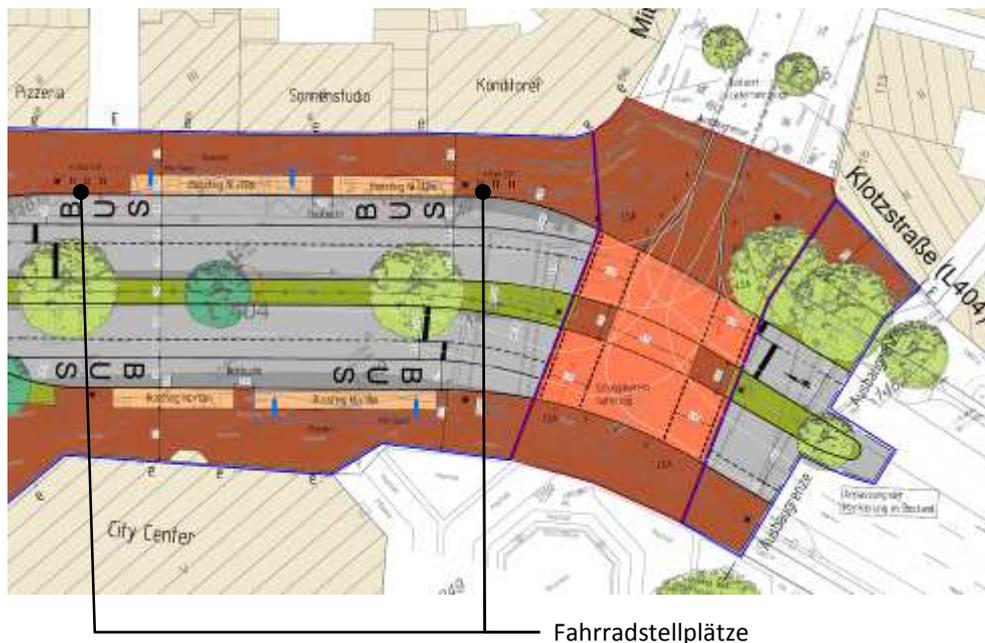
Südöstlicher Planungsabschnitt Variante 1
